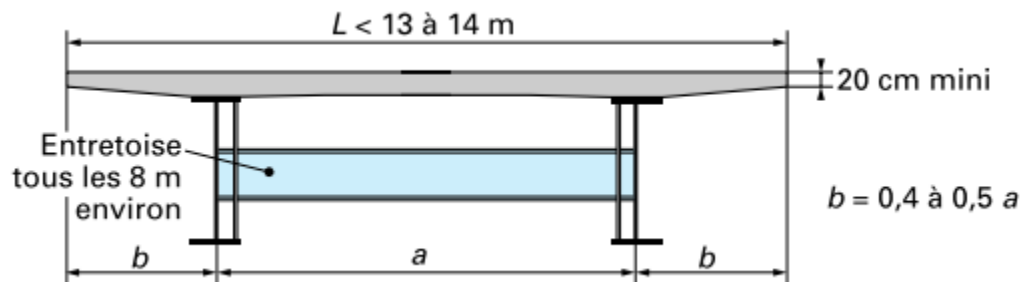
Eléments de conception transversale d'un tablier bipoutre entretoisé.
